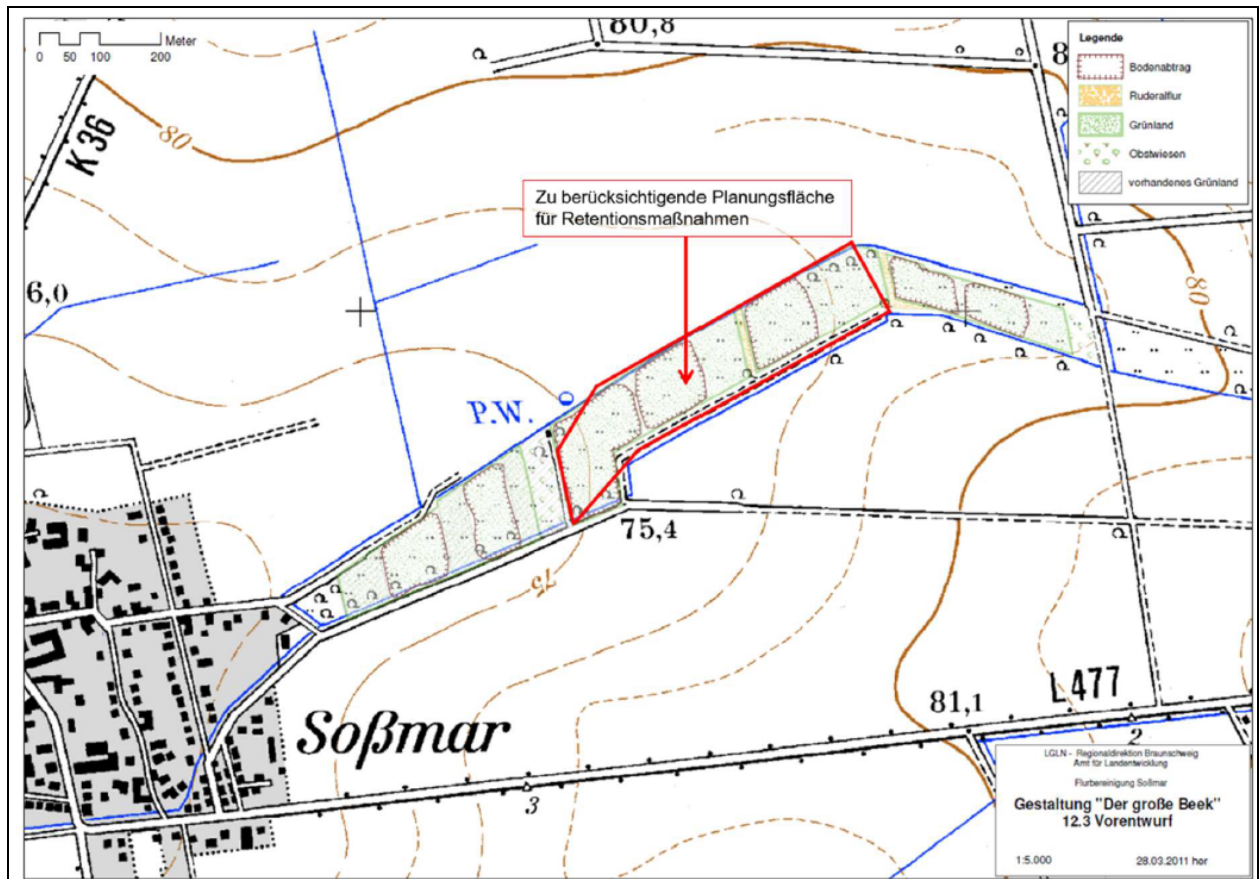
Skizze zum Rückhaltebecken (Lageplan)
